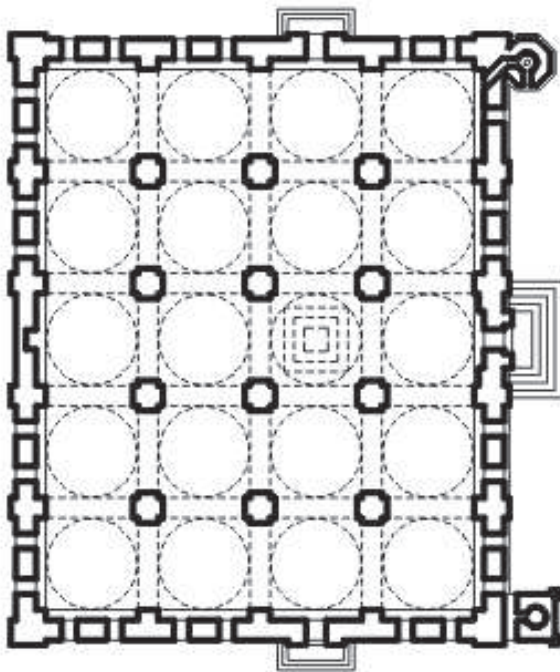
Ulu Camii, 1396. Planta. (Dibujo del autor)
